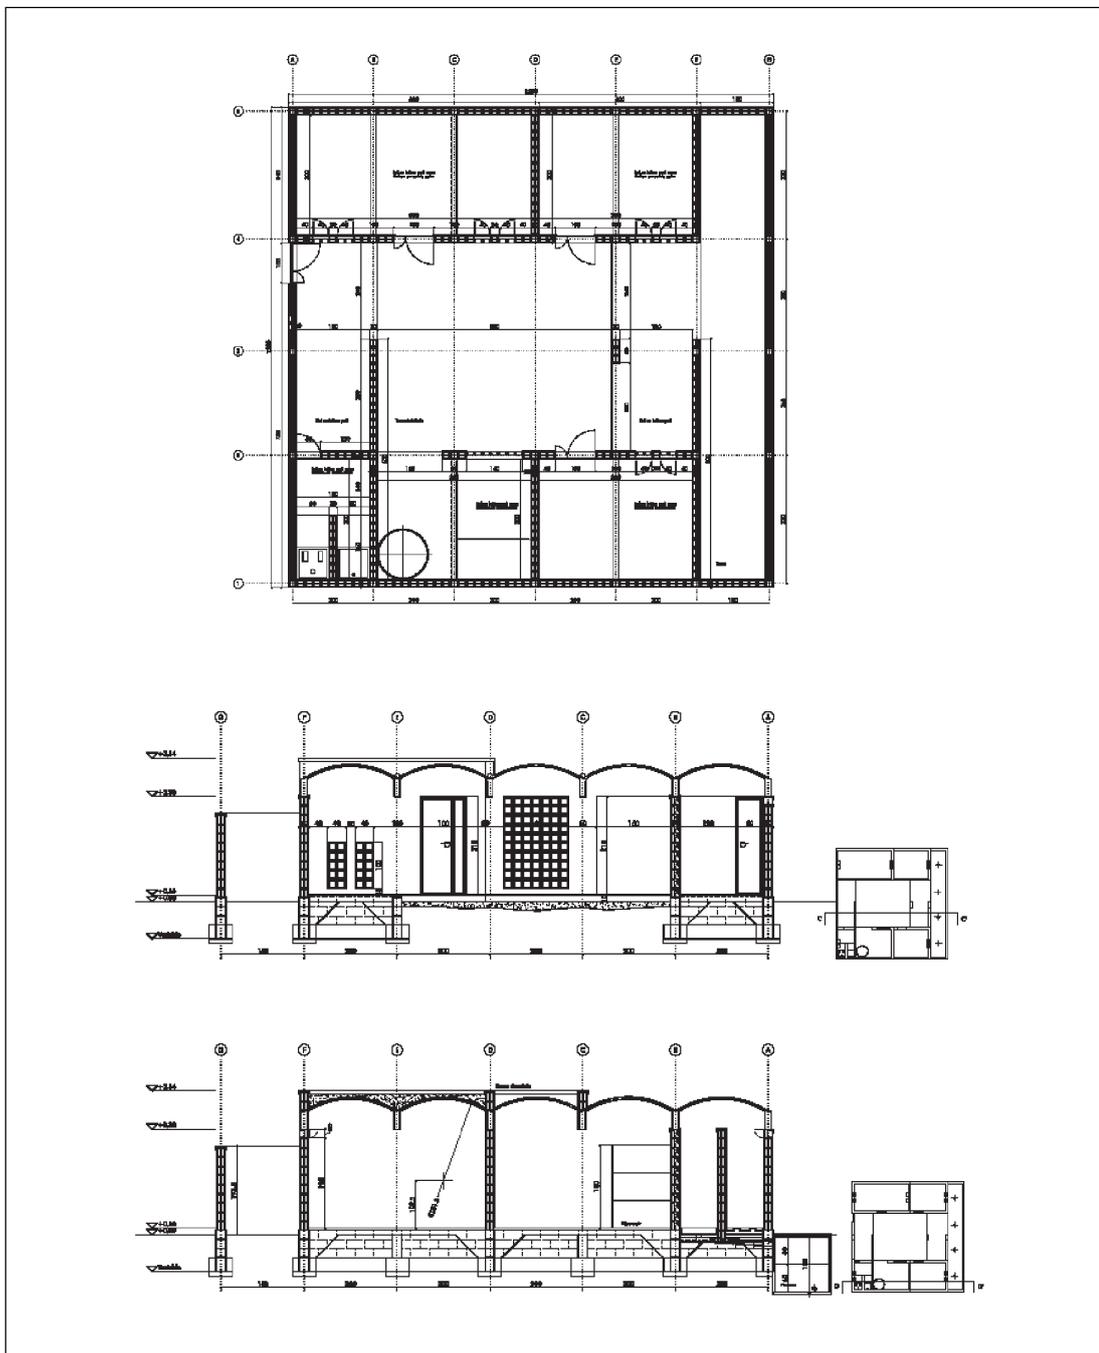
Planta general y dos secciones frontales de una vivienda completa en su fase inicial. (J.J. Legarra).
